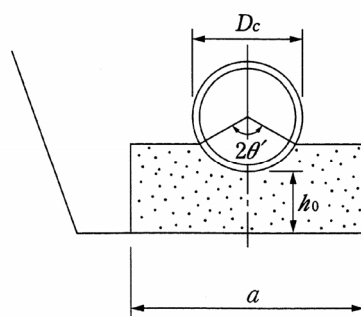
コンクリート基礎の形状 (半巻き基礎)
